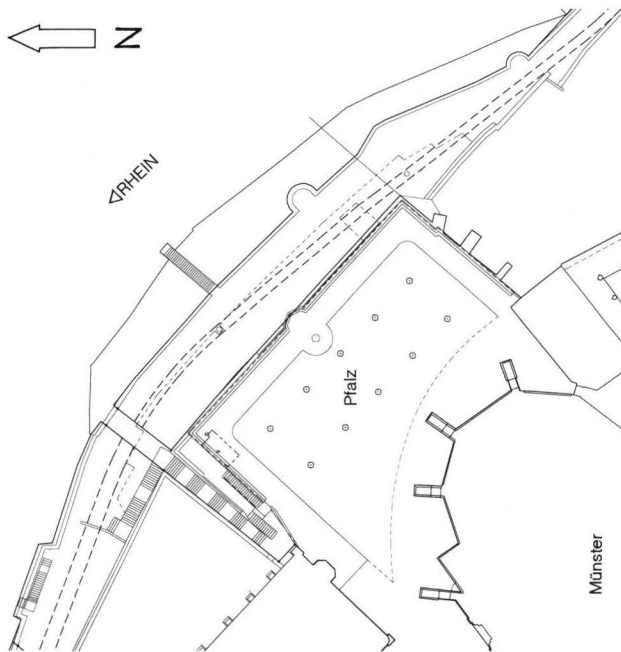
Grundriss der Pfalz. – Zeichnung: U. Schön.
